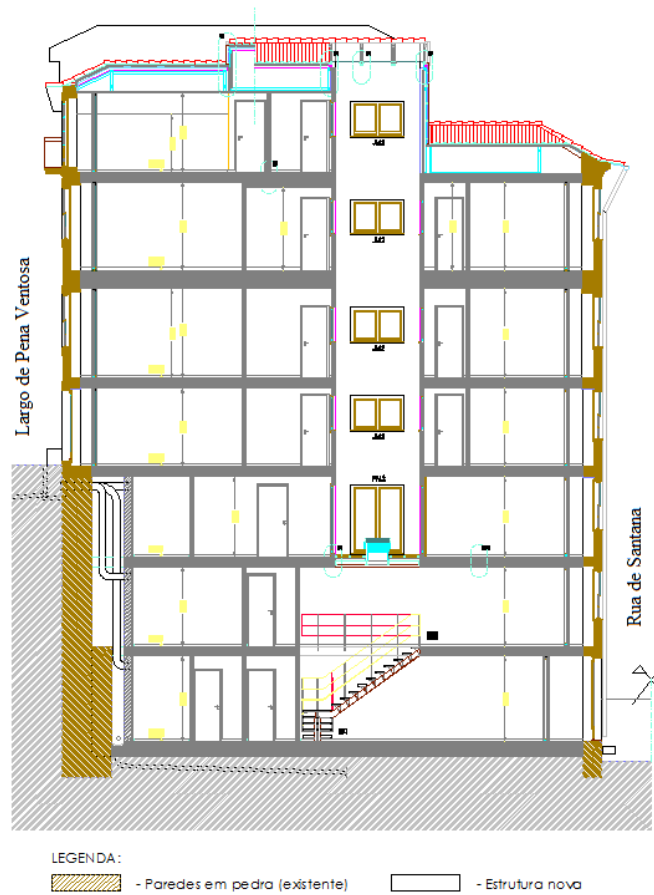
Corte transversal do edifício - Fonte: Projeto de arquitetura
